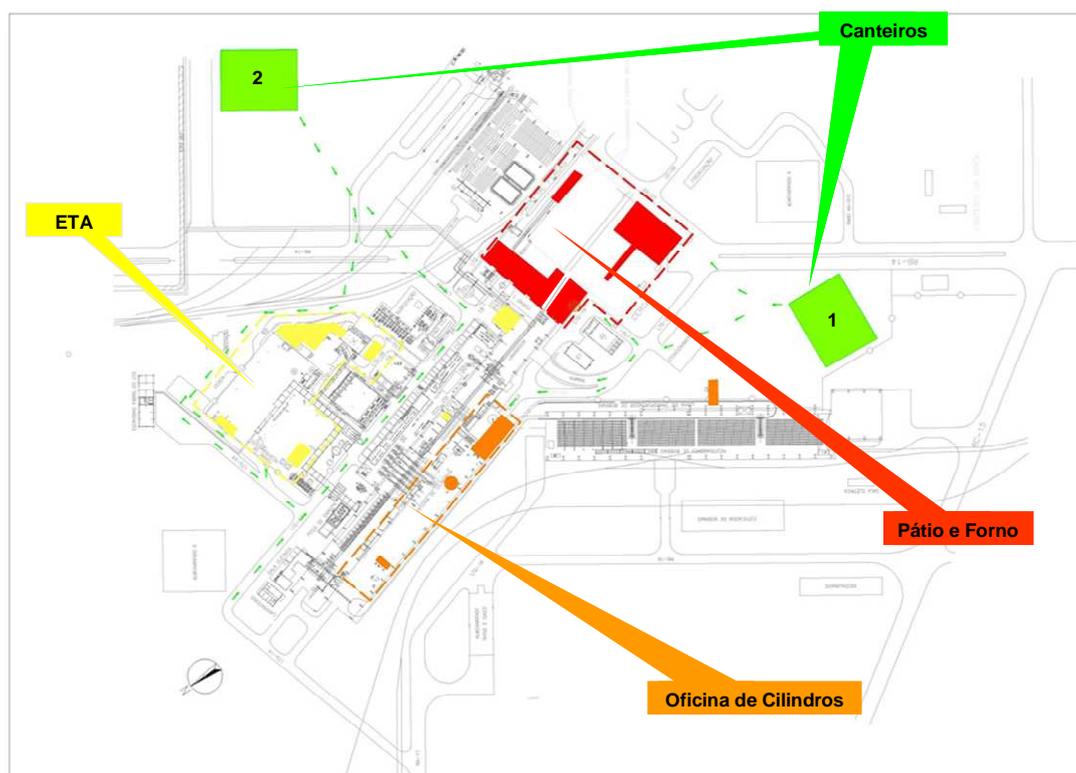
Layout do Laminador de Tiras a Quente com as áreas de risco.
